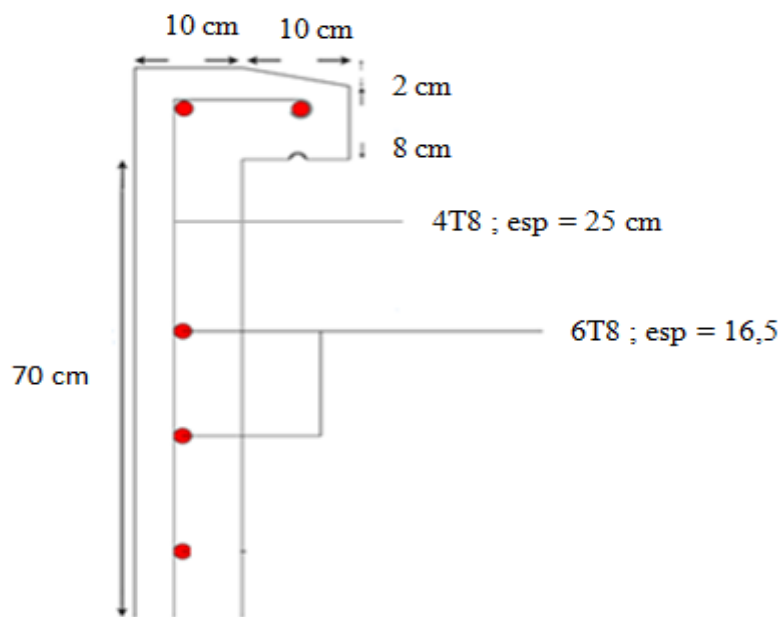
Schéma du ferrailage et coffrage de l'acrotère
